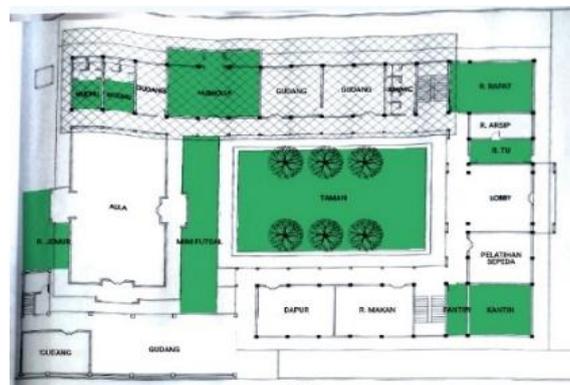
Denah lantai 2 dengan penerapan Kebutuhan Rasa Kepemilikan dan Cinta Kasih
